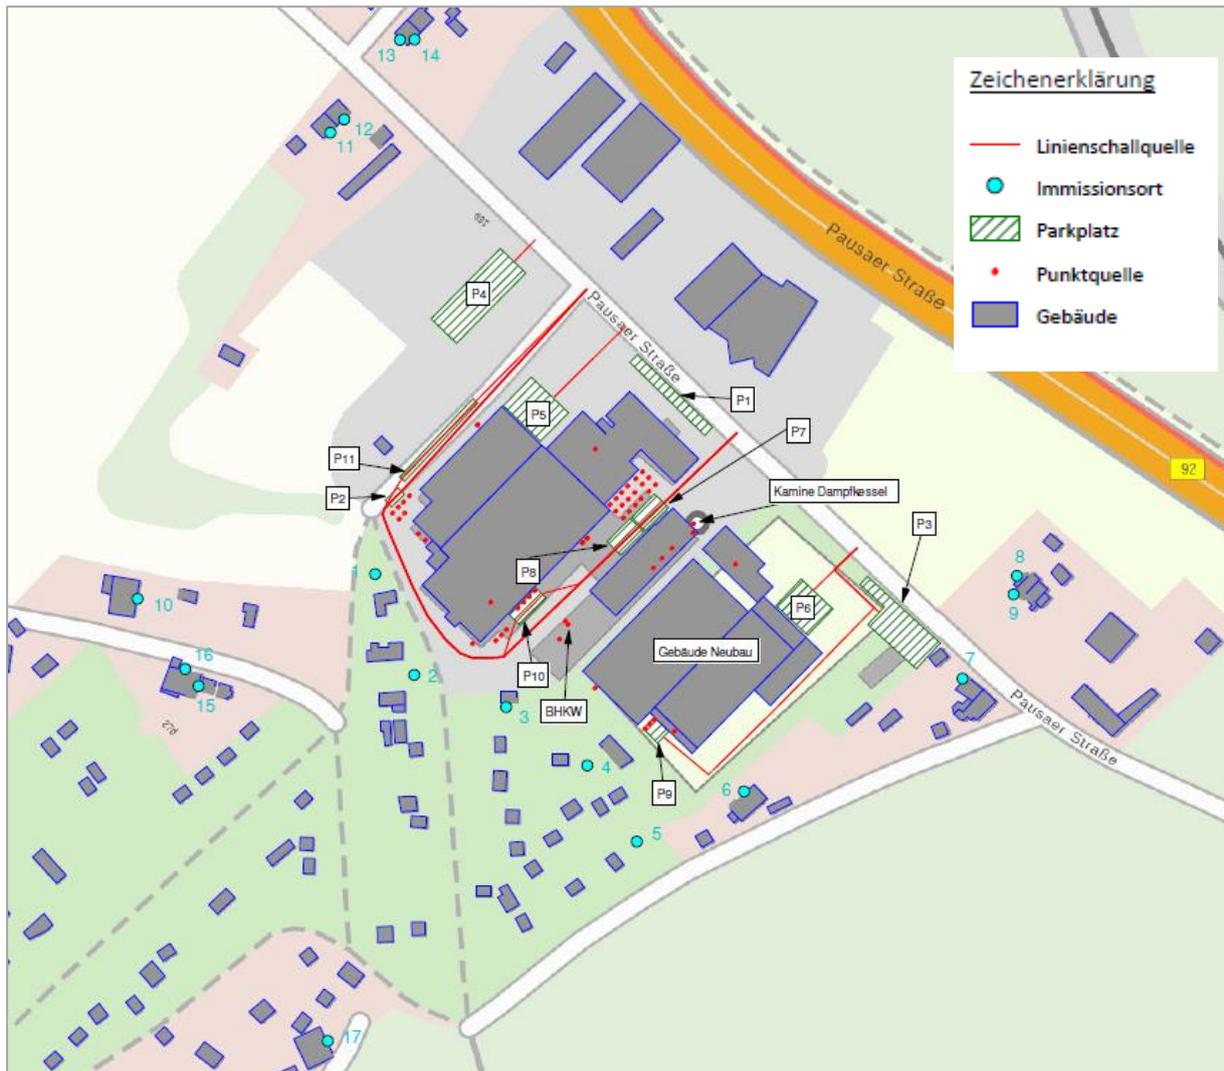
Lageplan mit Schallquellen und Immissionsorten Werktag, von G.U.B. Stand 17.01.2022
